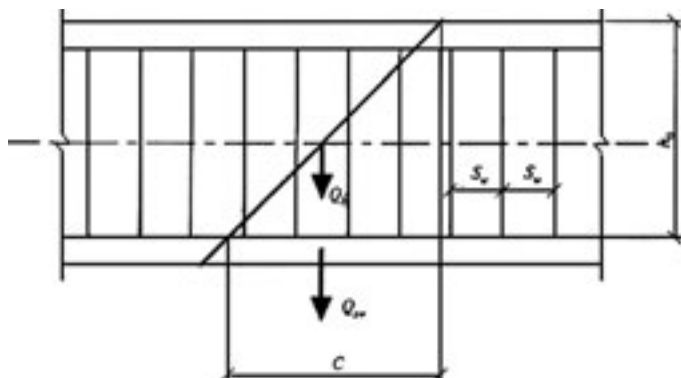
Схема усилий при расчете железобетонных элементов по наклонному сечению на действие поперечных сил
